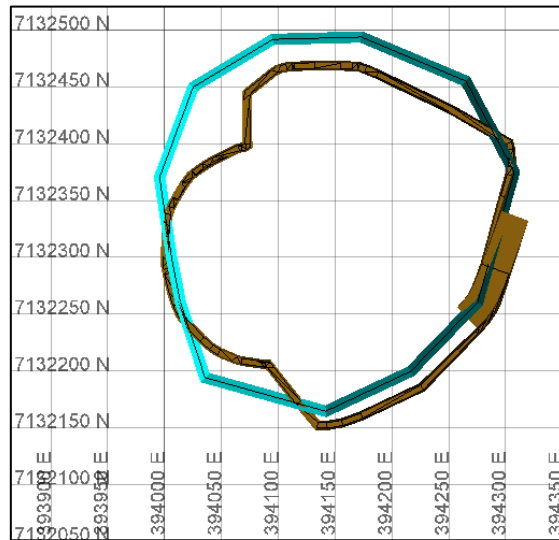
LGMMIY Fase 2 - Vista en sección - Planta banco 1090 (pit y diseño)
